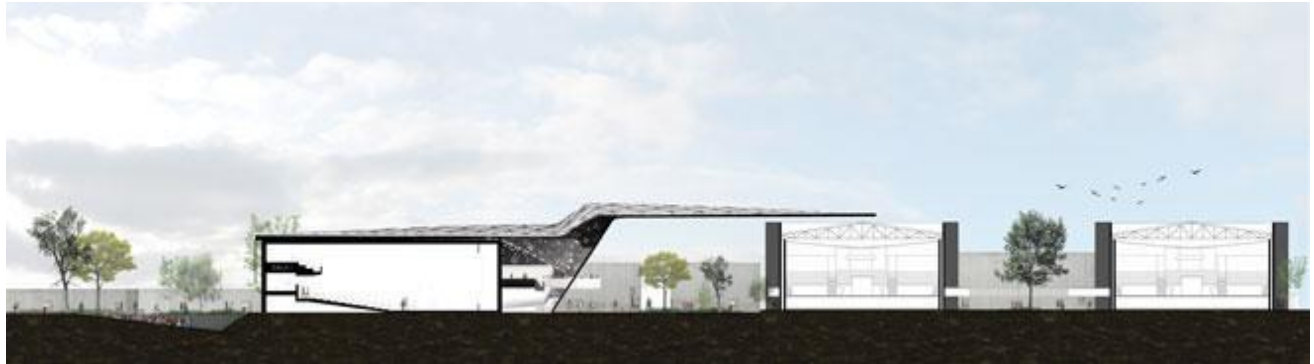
Corte Transversal del Conjunto. Vista de la armadura de acero. Fuente: [www.plataformaarquitectura.cl](http://www.plataformaarquitectura.cl)
